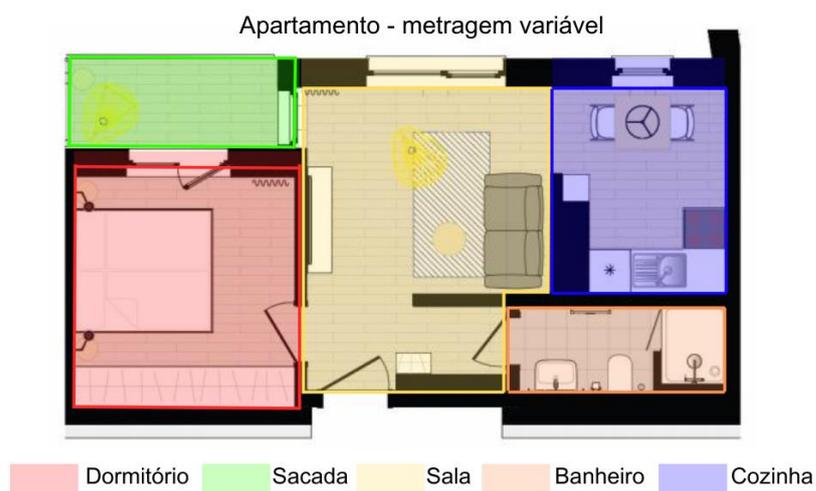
Setorização / Planta baixa apartamento. Alterado pelo autor.
